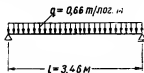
Расчетная схема панели и схема нагрузки.
